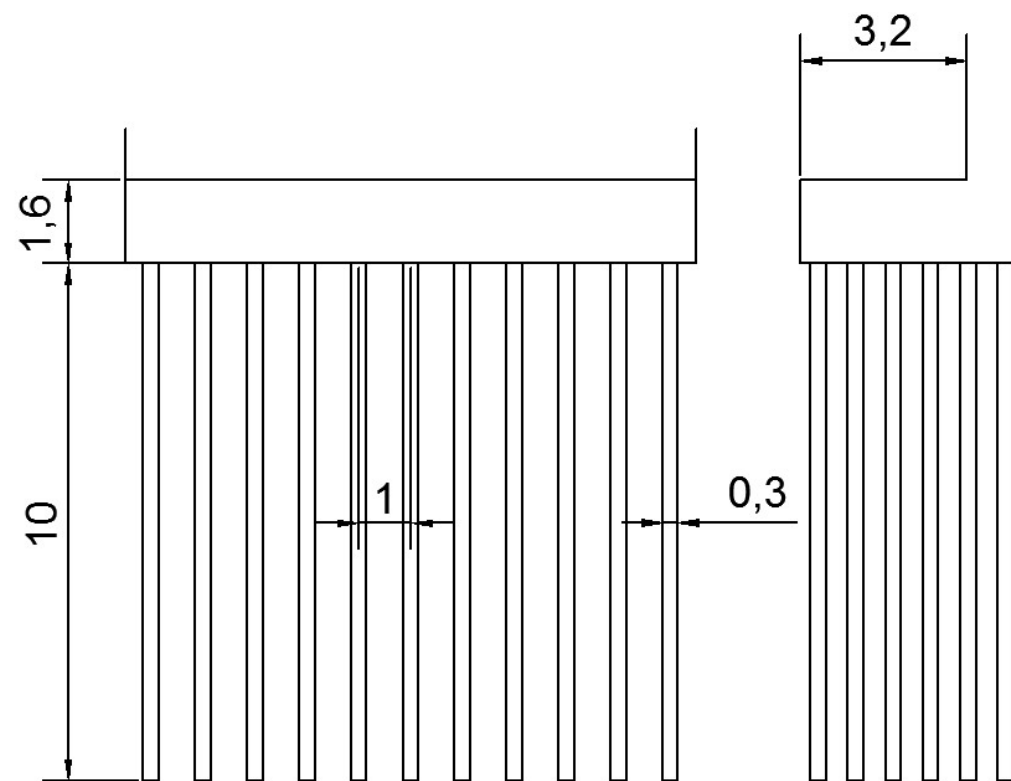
Croquis dimensiones cimentación estribo izquierdo
